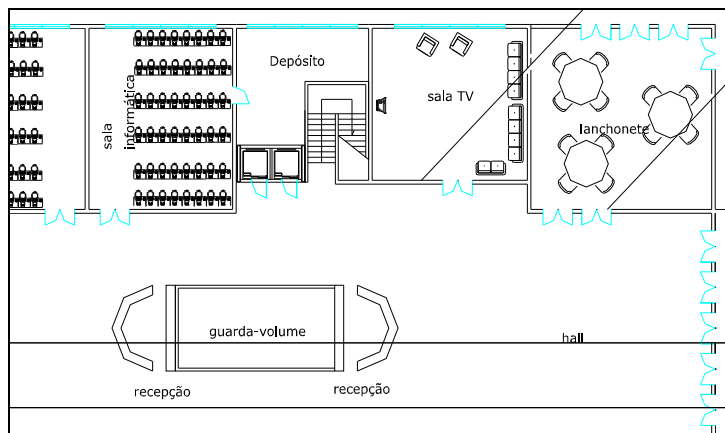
Área da recepção do pavimento térreo do Projeto "B" (s/esc.).
